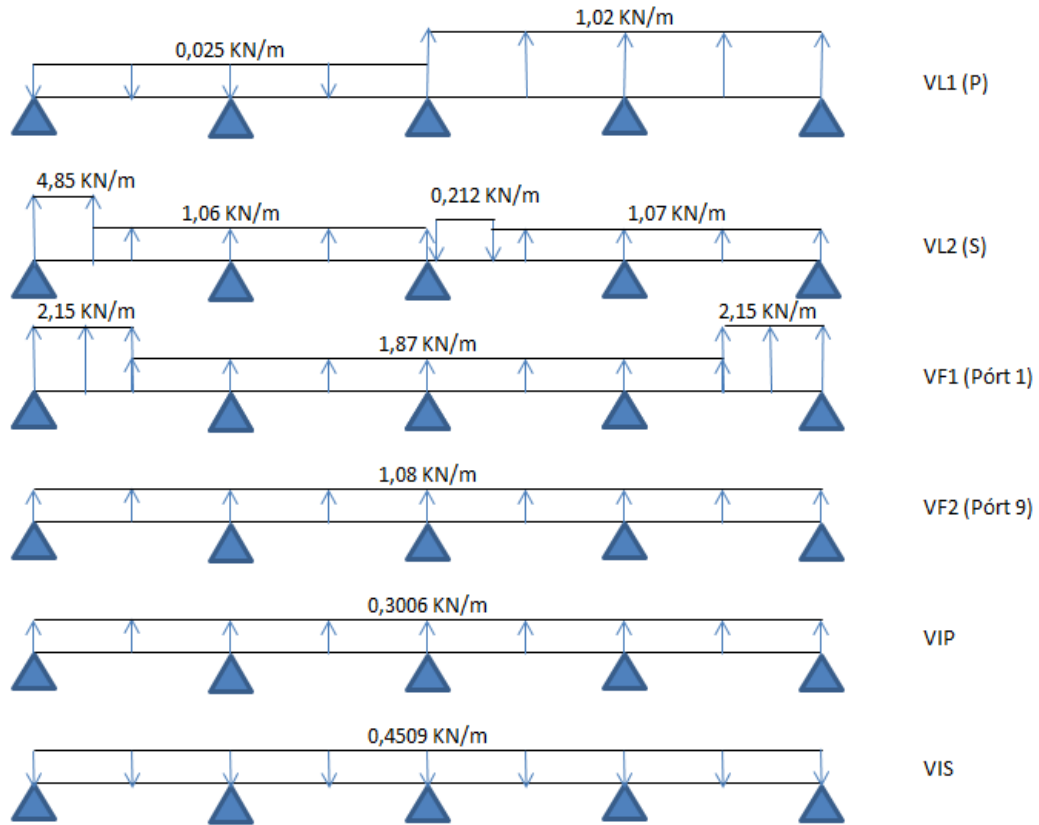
Acción del viento sobre la jácena del pórtico de fachada.
